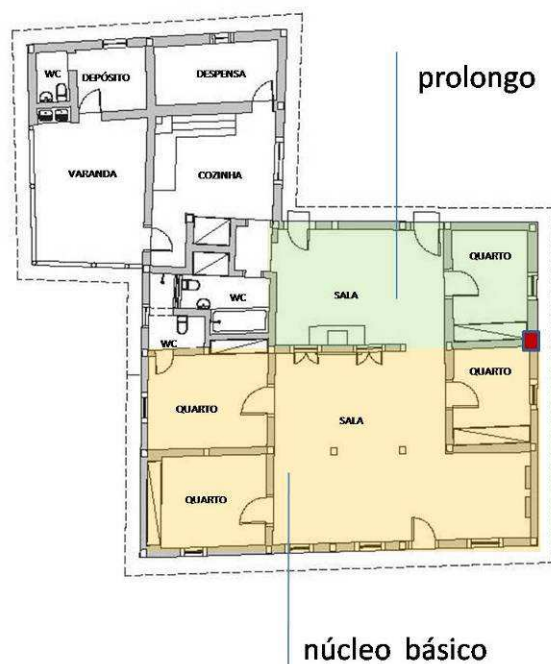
Moradia rural na Fazenda Saco Grande II – planta baixa.
